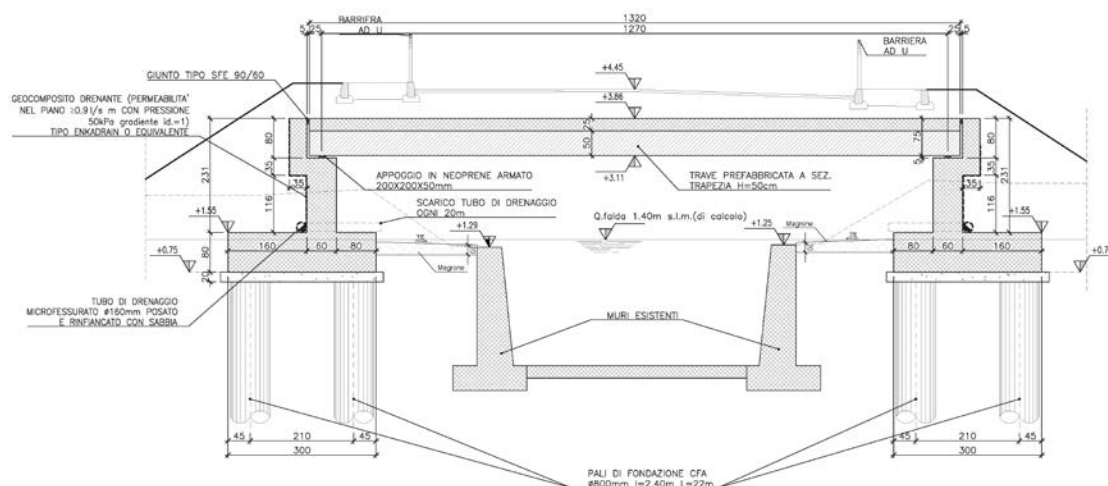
Impalcati 8 e 9 –Sezione trasversale
